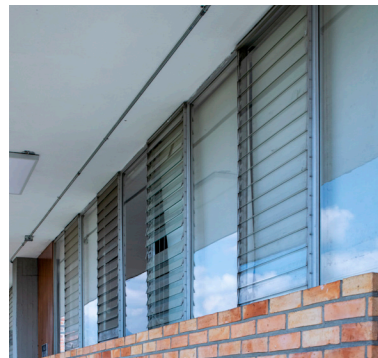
Detalle de ventanas en aulas bloque E2 segunda planta alta.
